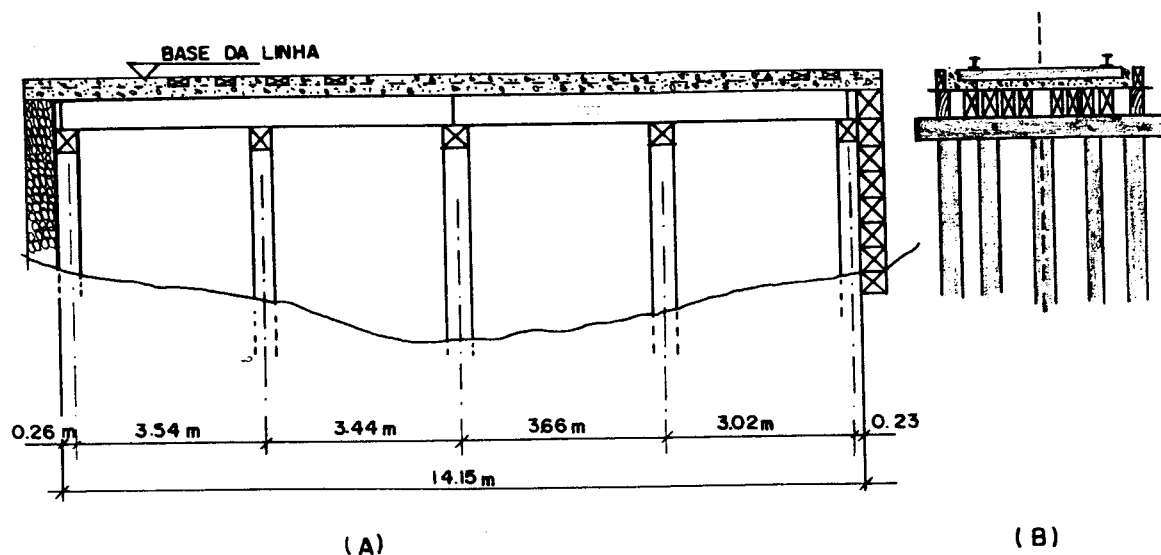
Ponte ferroviária em madeira com tabuleiro lastrado
